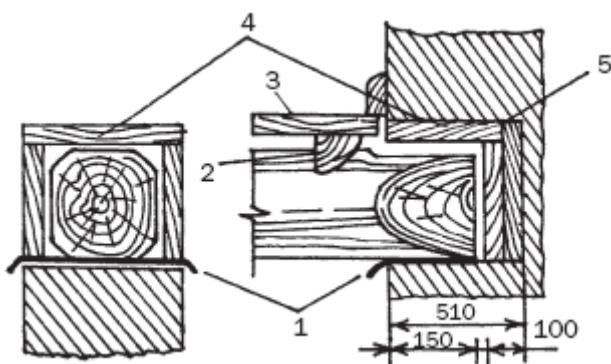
Заделка концов балок перекрытия (толщина стены – 2 кирпича): 1 – толь; 2 – лага; 3 – пол; 4 – половая доска; 5 – войлок
